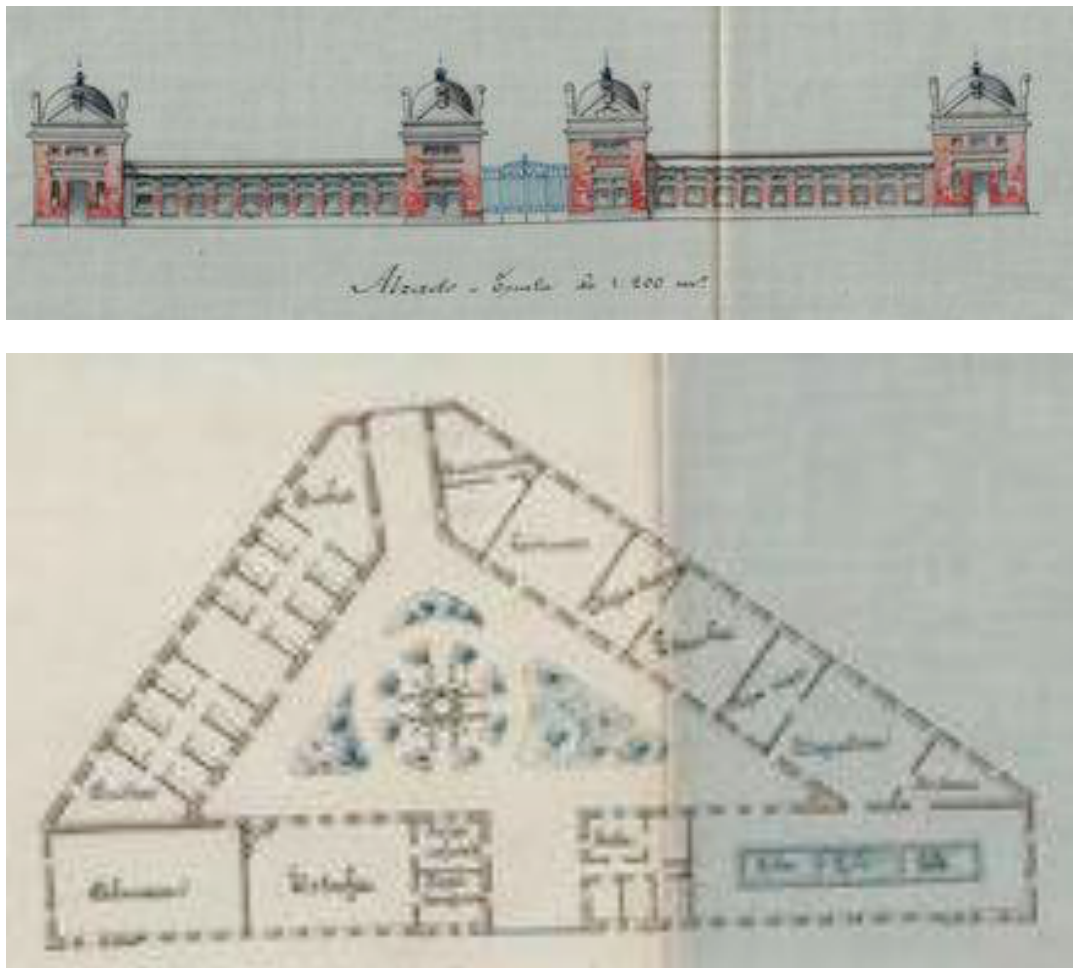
Planta y alzado de los Baños del Barrio del Norte. 31 de diciembre de 1902. AMC.
